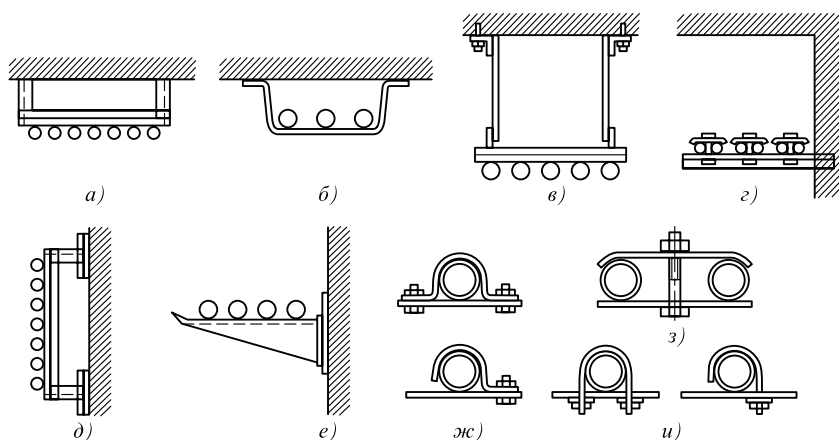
Опорные и крепежные конструкции и детали для трубных проводок:
